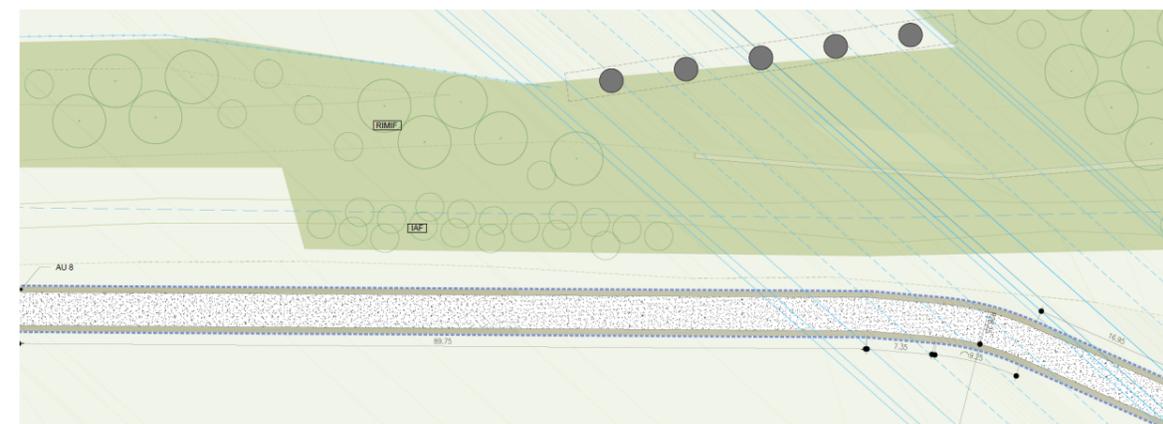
Particolare sottopassaggio ponte sul Reno²²
